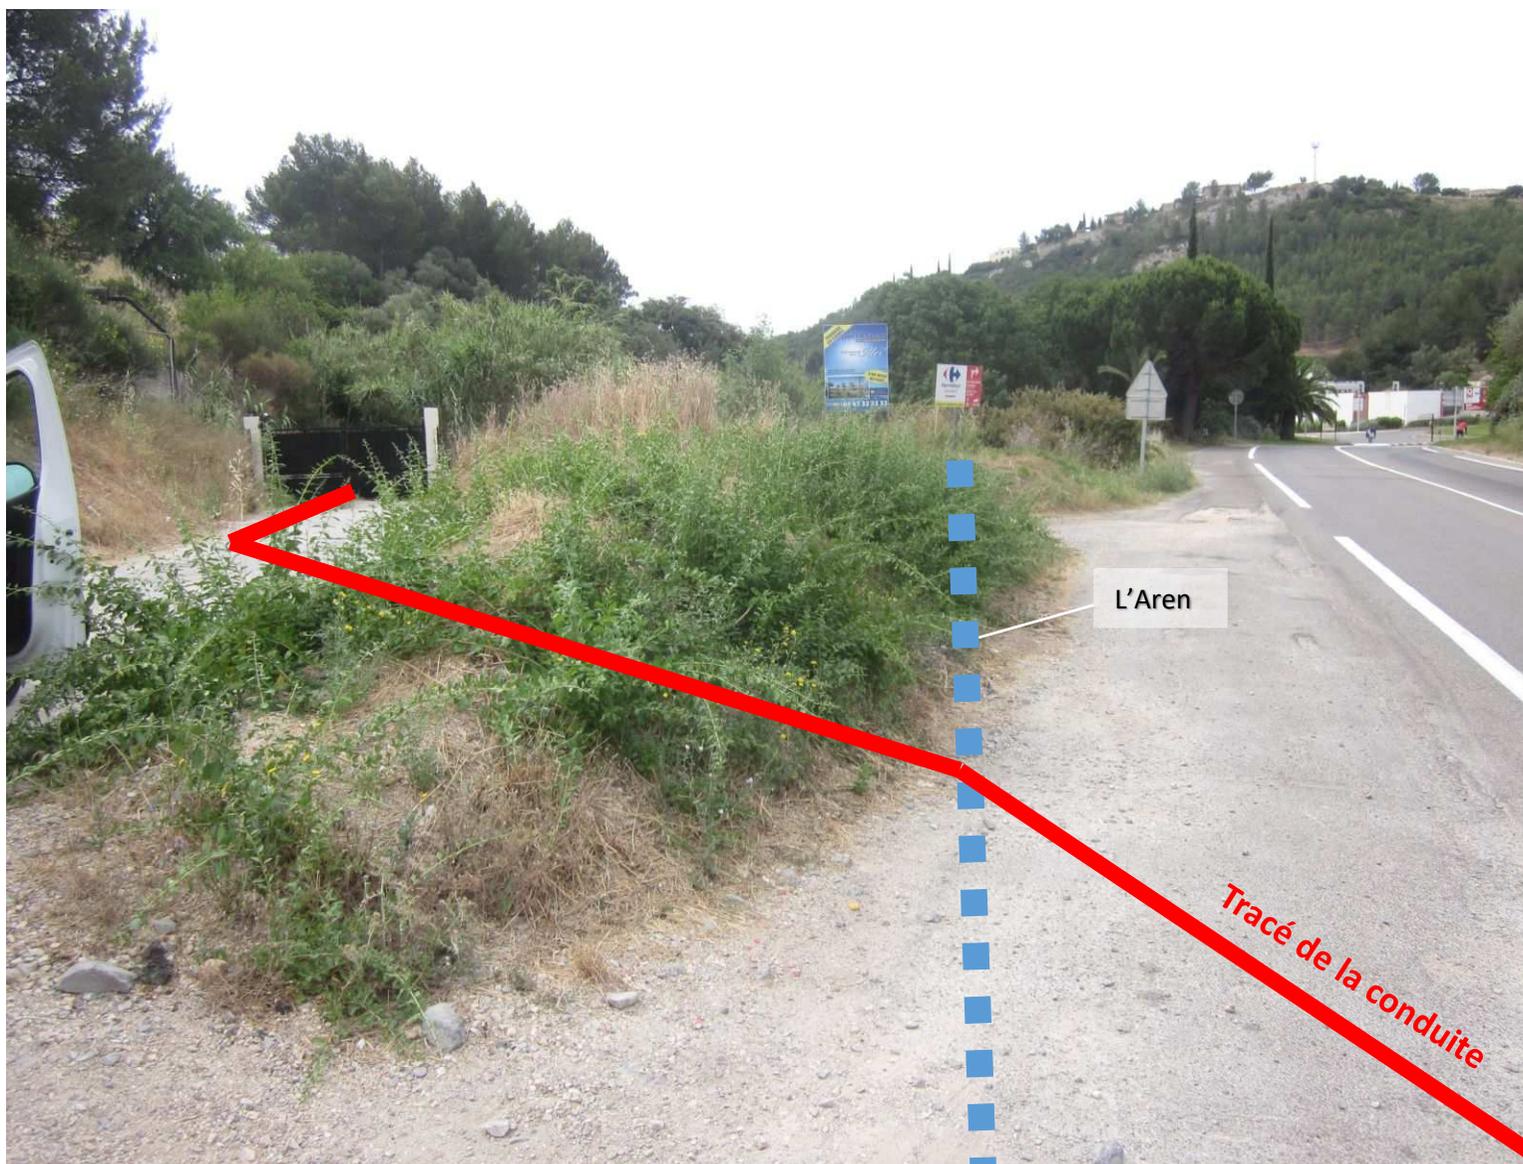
Tronçon Maillage Nord-Sud : Traversée de l'Aren au droit où la RD 559b recouvre le lit. Les travaux ne nécessiteront donc pas d'intervention dans le lit du cours d'eau.
